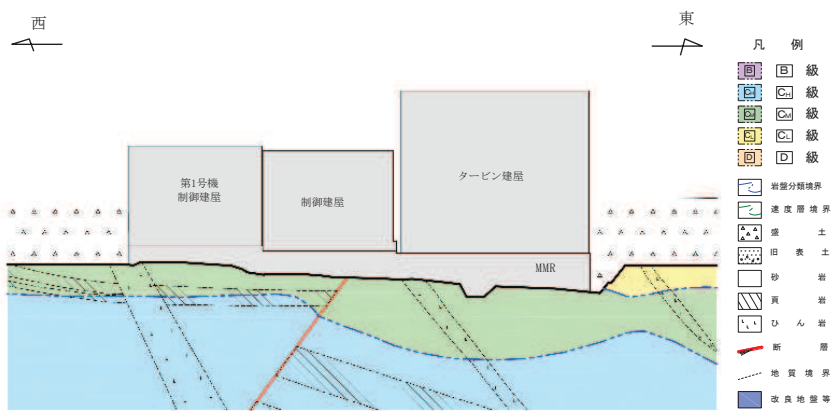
(4) 補助ボイラー建屋の基礎断面図 (D-D 断面, EW 方向)
